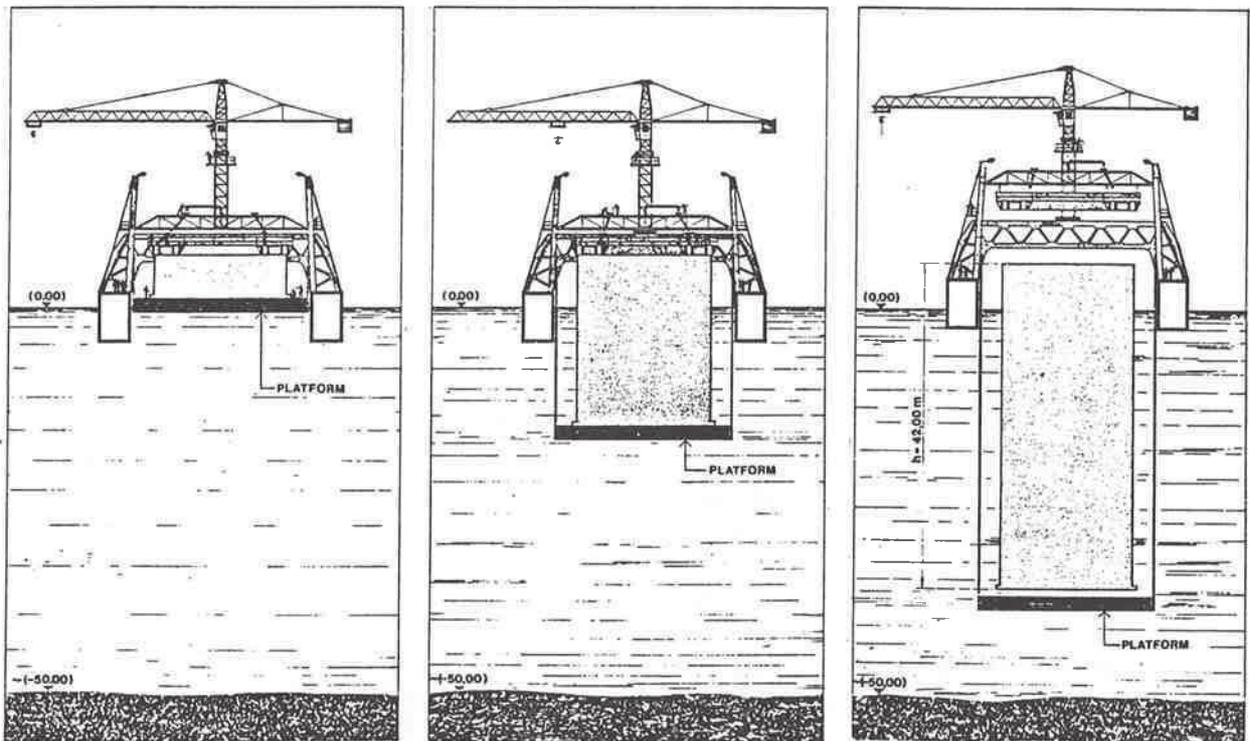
Fasi tipiche di prefabbricazione con impianto galleggiante
